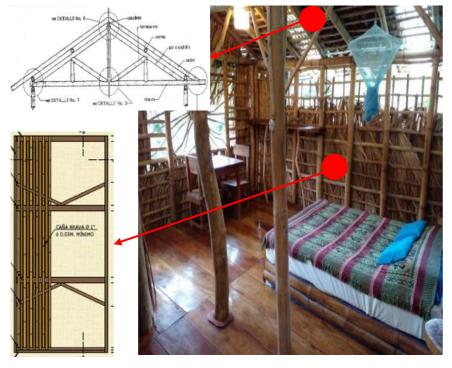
Concepto constructivo Fuente: Elaboración propia
